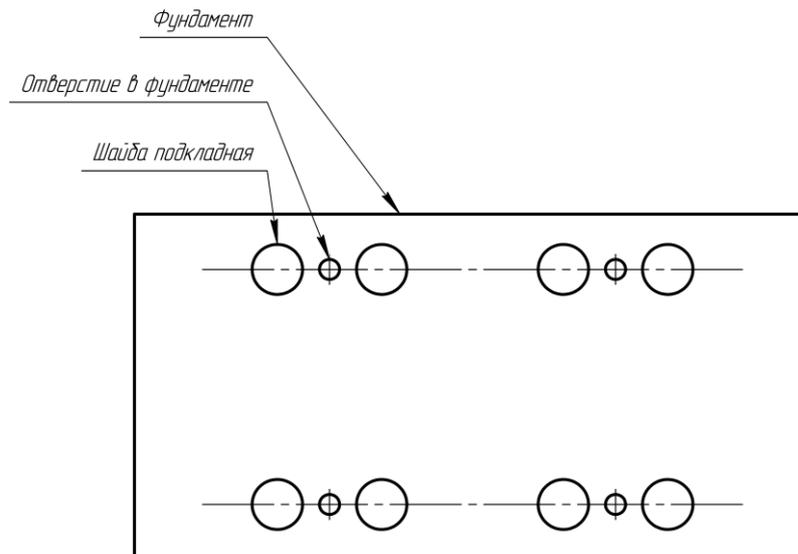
Схема расположения шайб на фундаменте (вид сверху)
